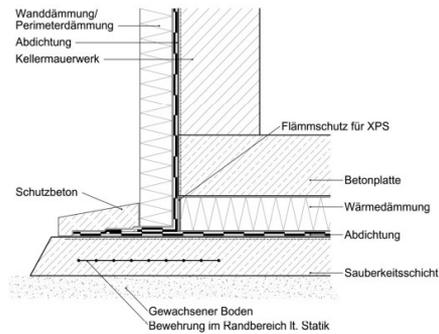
Übergang der Horizontalabdichtung zur Wandabdichtung, sogenannter rückläufiger Stoß
